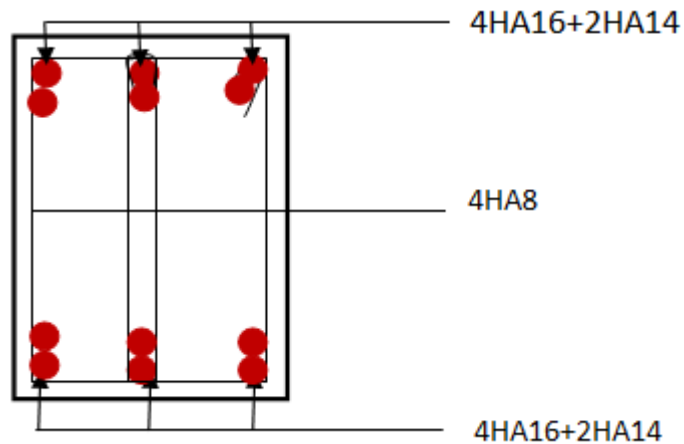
Ferrailage aux appuis d'une poutre principale.
